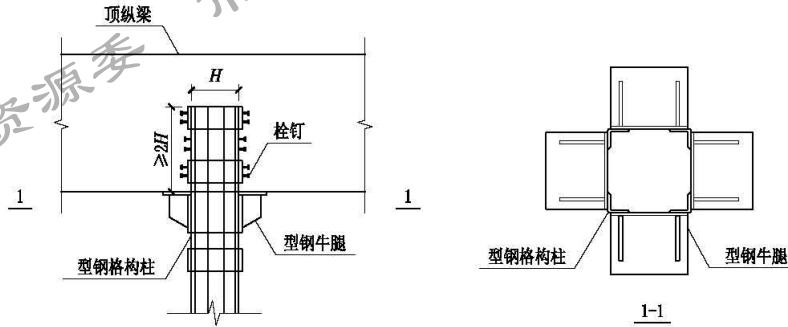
型钢混凝土柱与顶纵梁插入式连接节点示意
